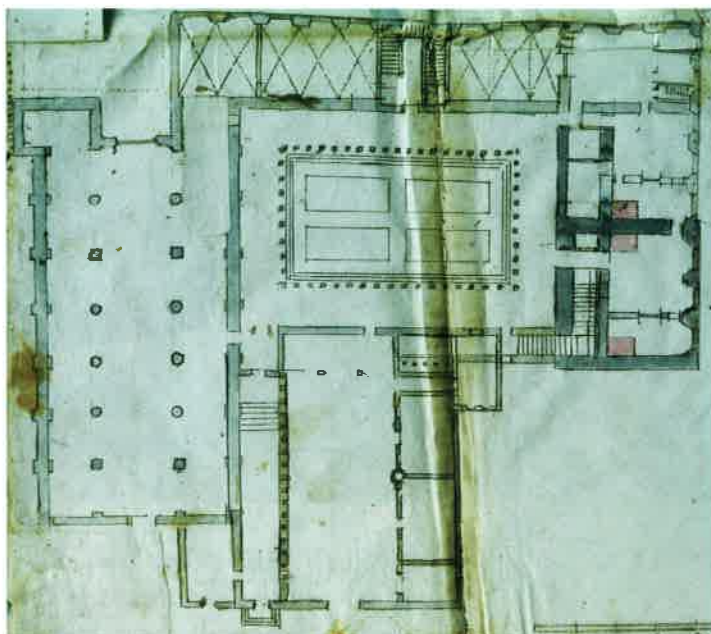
plans du rez-de-chaussée du prieuré de Fontaine en 1702 (A.D. Haute-Saône, H 568).
